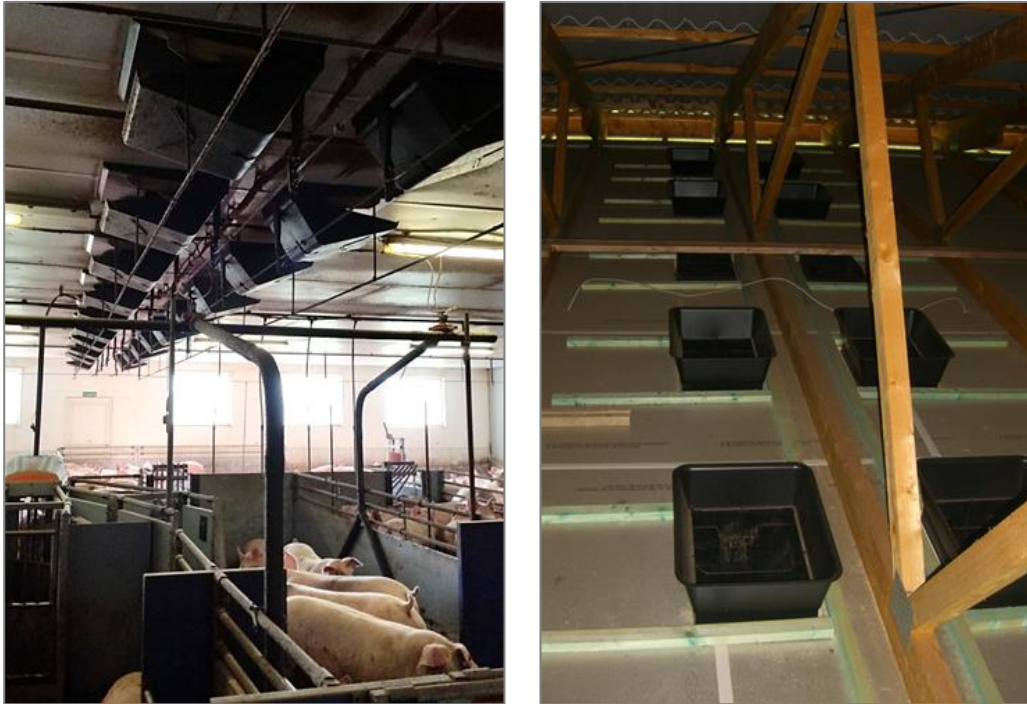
Deckenventillüftung (links Abteilansicht/ rechts Dachraumansicht)
